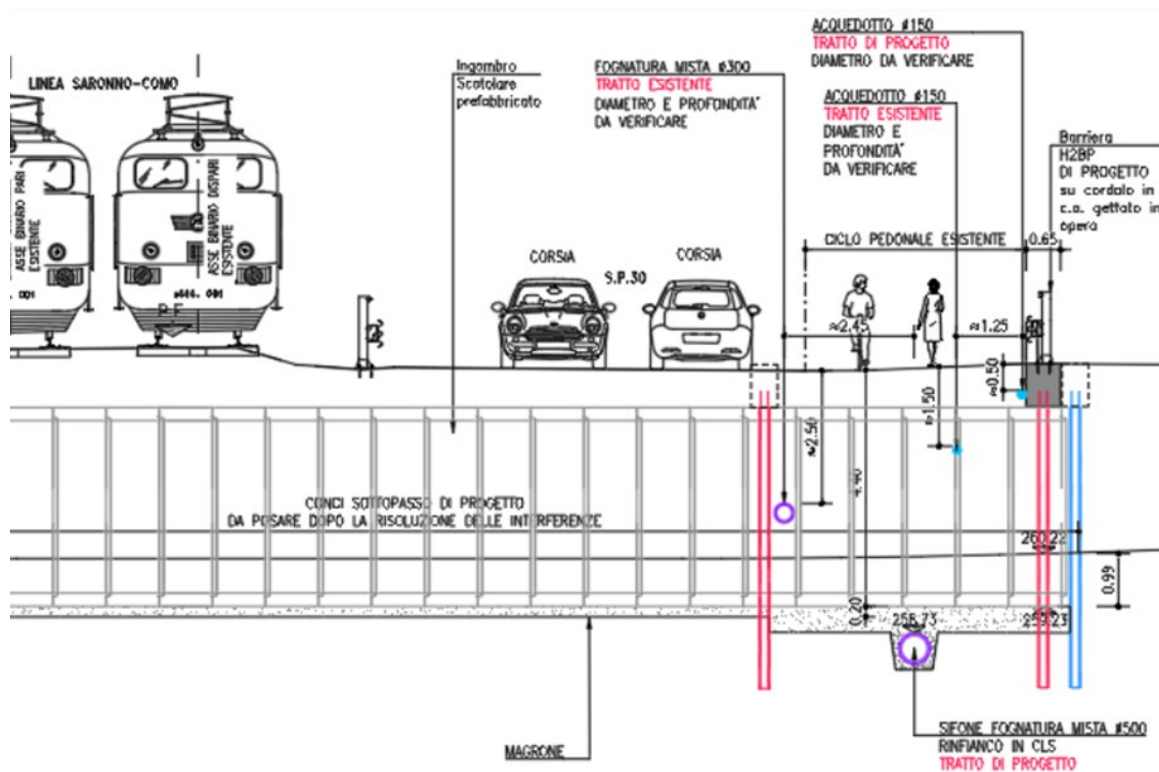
Sezione longitudinale sottopassaggio, rete acquedottistica e fognaria pubblica di progetto
